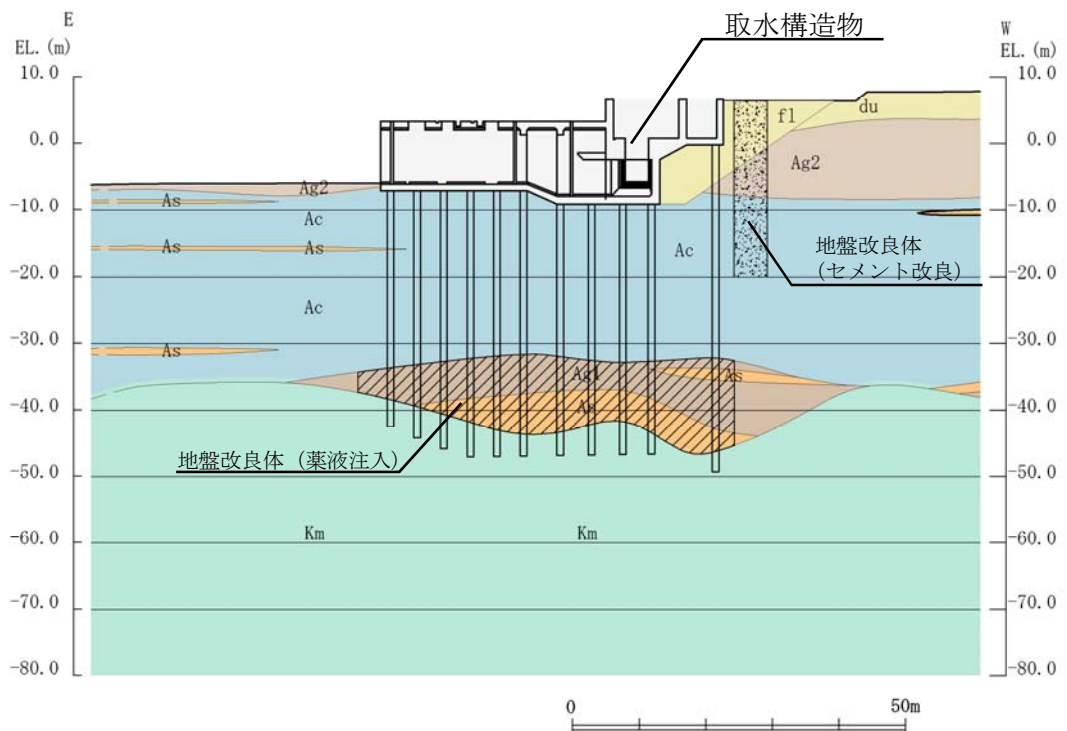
(3) 地質断面図 (⑥-⑥断面)
